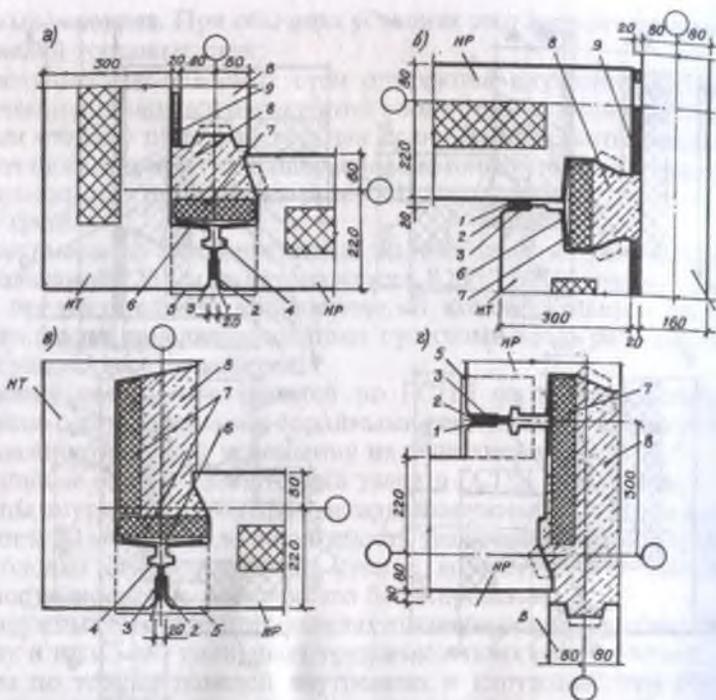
Закрытый дренажный вертикальный стык наружных стен из керамзитобетонных панелей с теплоизоляционными вкладышами:
